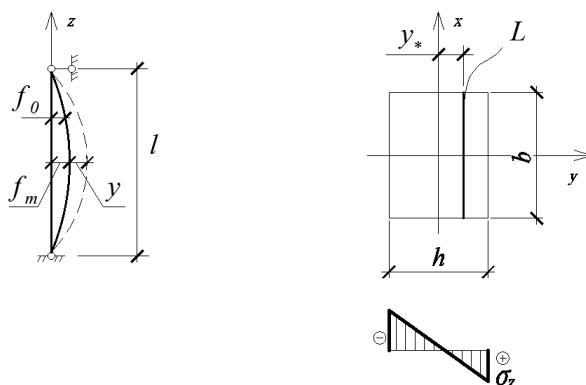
Расчетная схема сжатого стержня с начальной погибью
